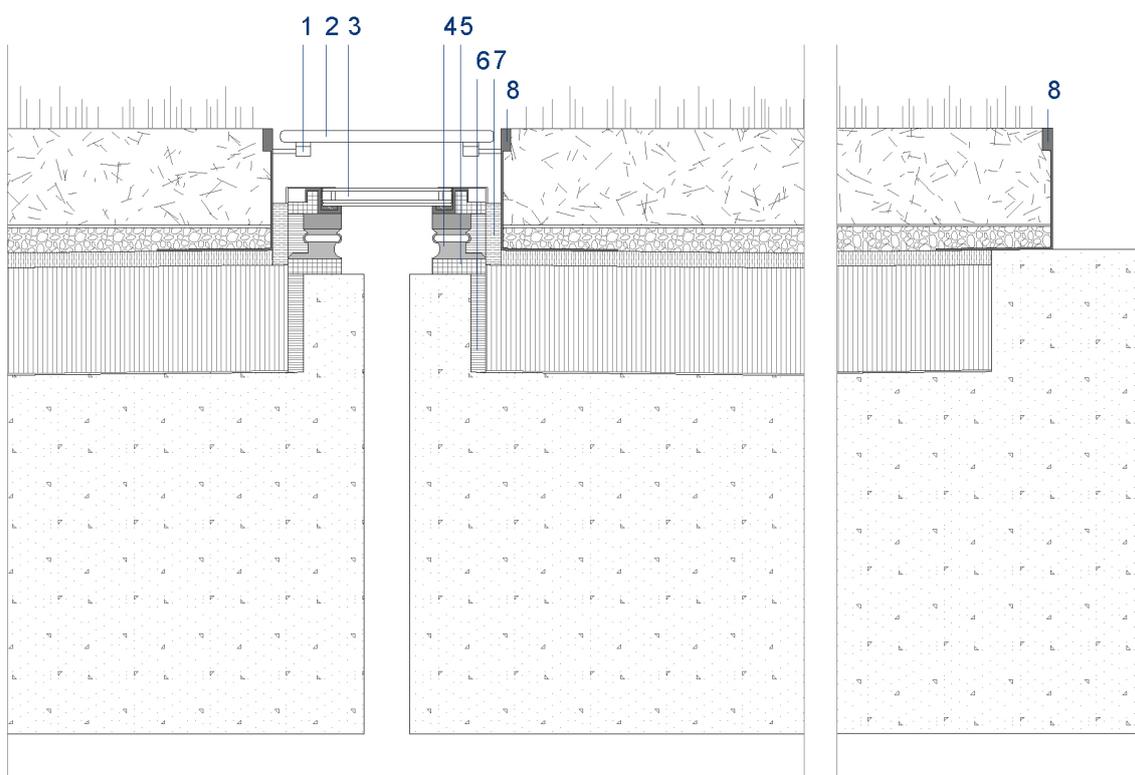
Detalle de la junta de la cubierta E: 1/10.
